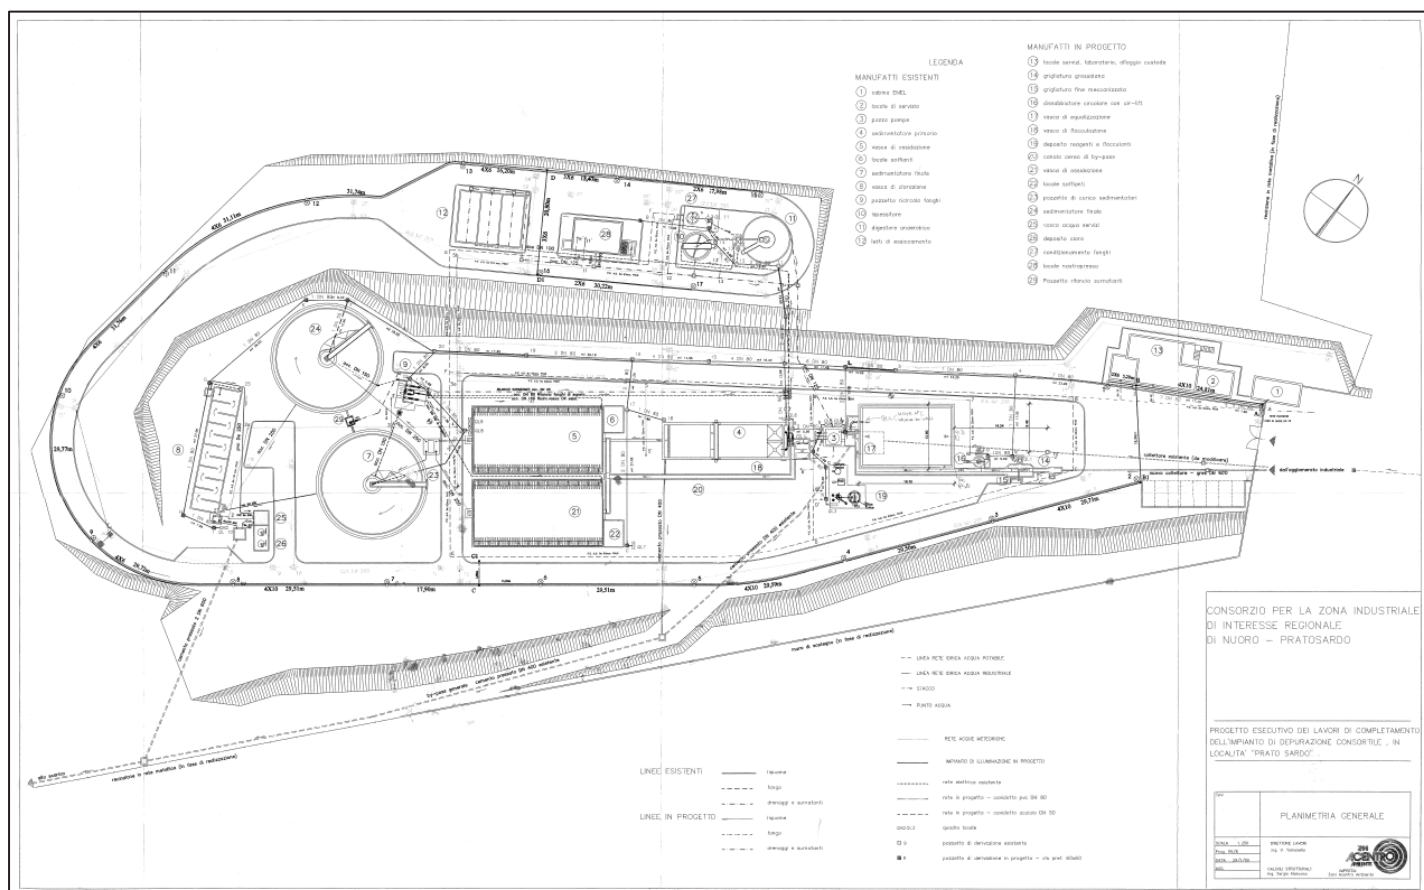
Planimetria generale dell'impianto di depurazione acque di Protosardo
